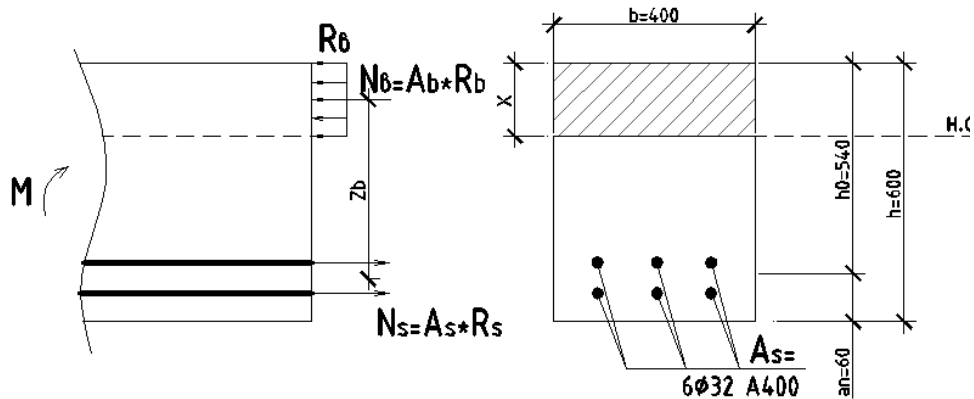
Схема внутренних усилий главной балки над залом в середине пролета
